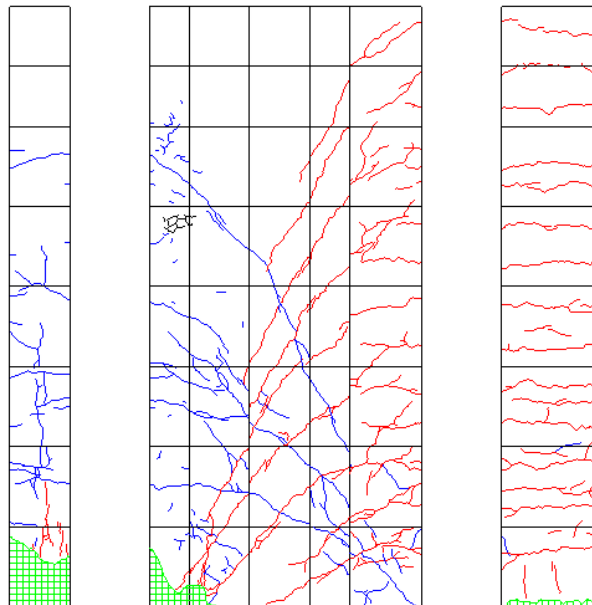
R=-1/33②ひび割れ図
